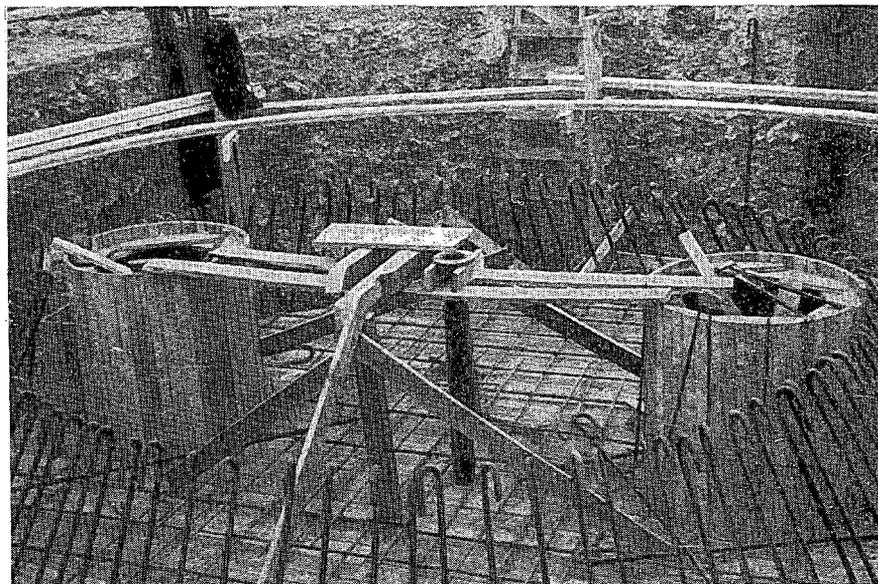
Encofrado y ferralla de una cámara de trabajo.
